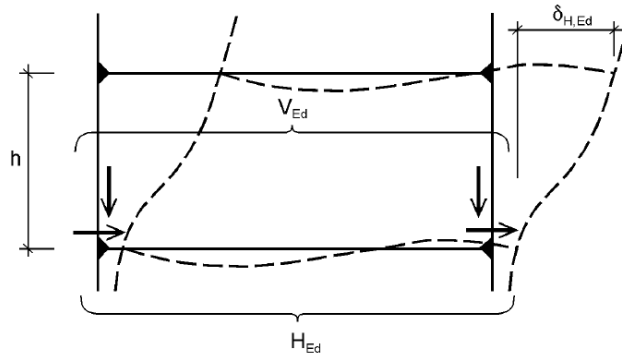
Deslocamentos verticais em um pórtico não contraventado (Fonte: [6])
